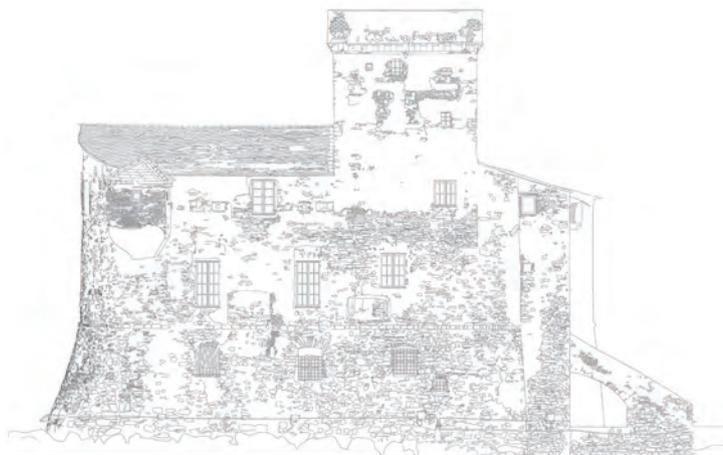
Restituzione fotogrammetrica del prospetto est
